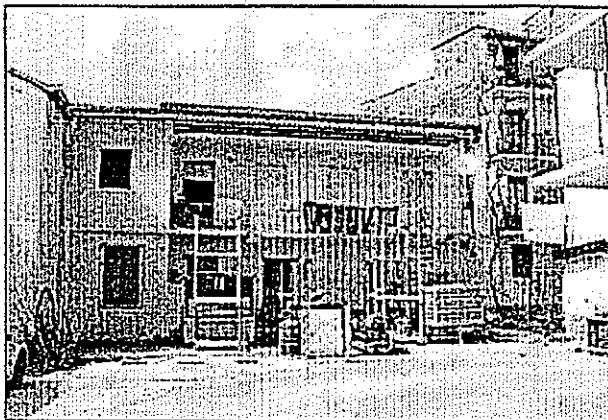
Alloggio di Via S. G. n° 37-1° piano (sub. 4 e 9)
